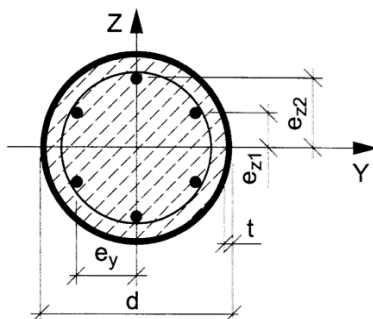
Поперечное сечение сталежелезобетонной колонны круглого сечения
